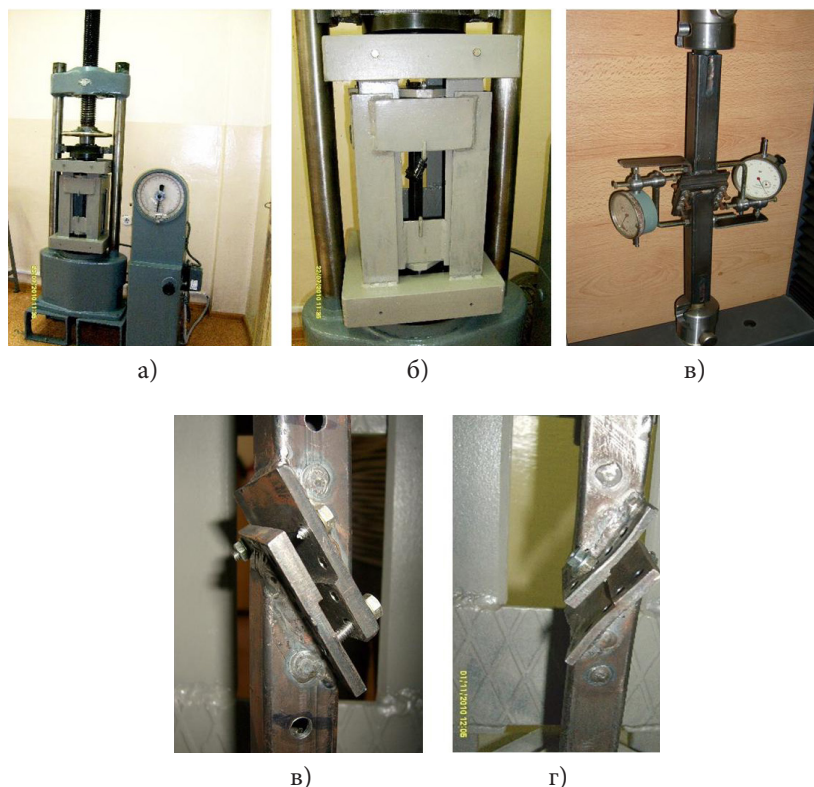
Снимки общего вида испытательной установки (а), ее реверсивной части (б), опытного образца с механическими индикаторами перемещений (в), опытного образца с болтовыми соединениями после их разрыва (г), опытного образца после разрушения из-за изгиба фланцев (д)
